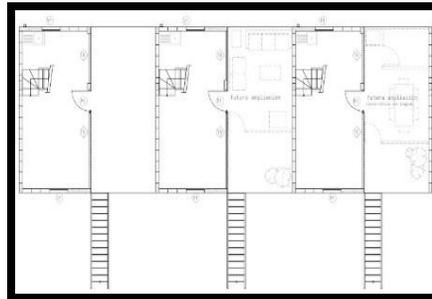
Plan du 1er étage du projet.(source:archdaily.com).
